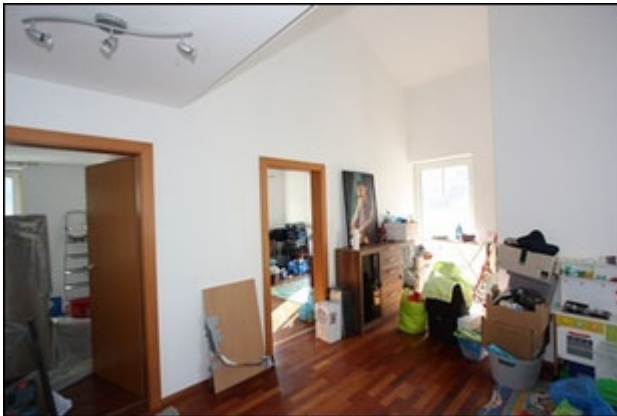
Ansicht Wohngebäude (DG), Zimmer 4 (vgl. Beilage 7.3)
